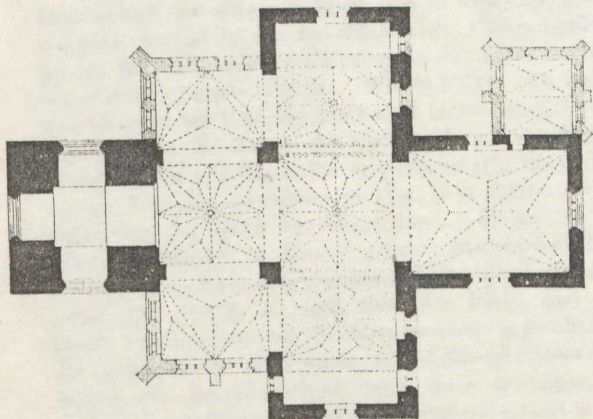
Greifenhagen: Nicolaikirche, Grundriss. 1:500.
